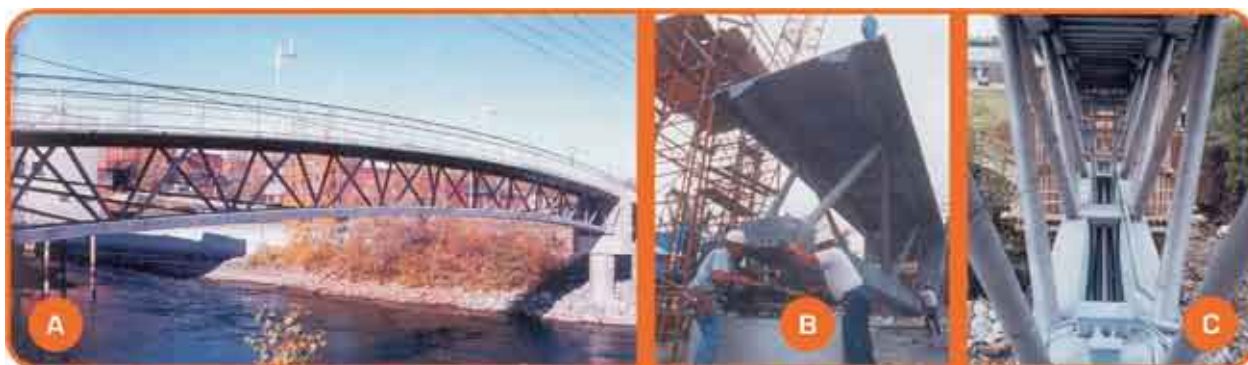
Passarela em Sherbrooke – primeira aplicação de RPC: a) vista geral, b) montagem de módulo pré-moldado e c) vista interna mostrando os cabos de protensão [BLAIS & COUTURE (1999)]
